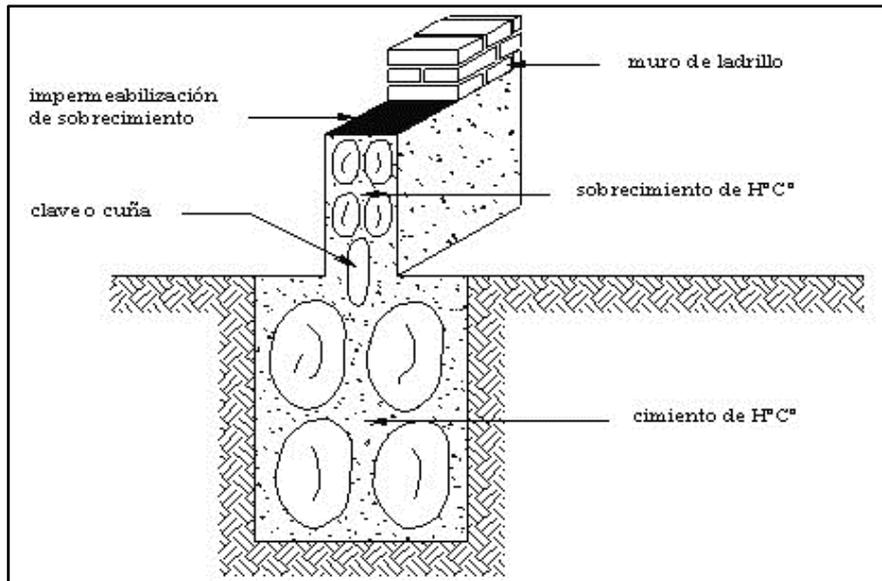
Cimentación con hormigón ciclópeo.<sup>81</sup>
